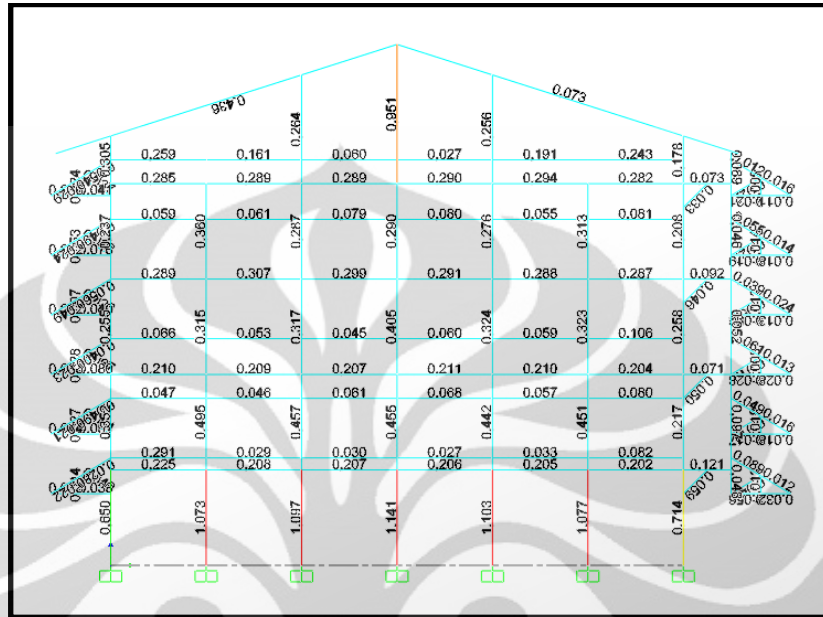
1 Layout Struktur Bangunan Pengeringan Karet
